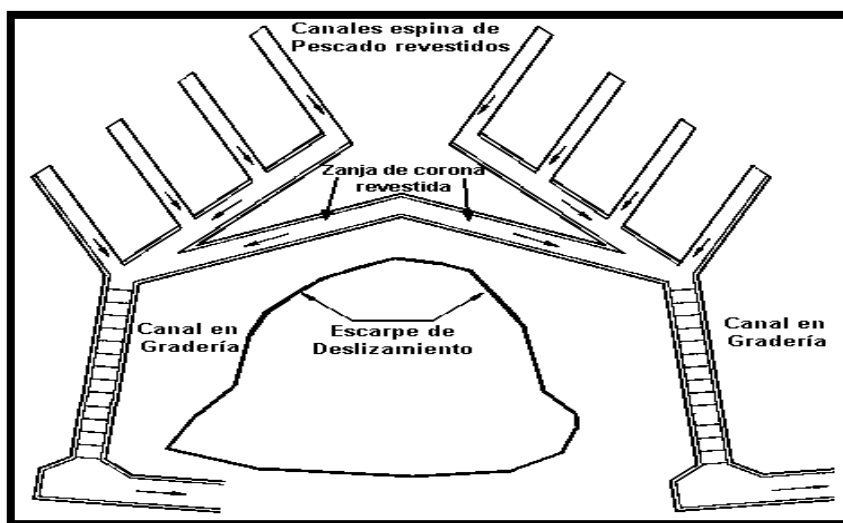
Esquema en planta de canales colectores espina de pescado (Suárez, 1998).
